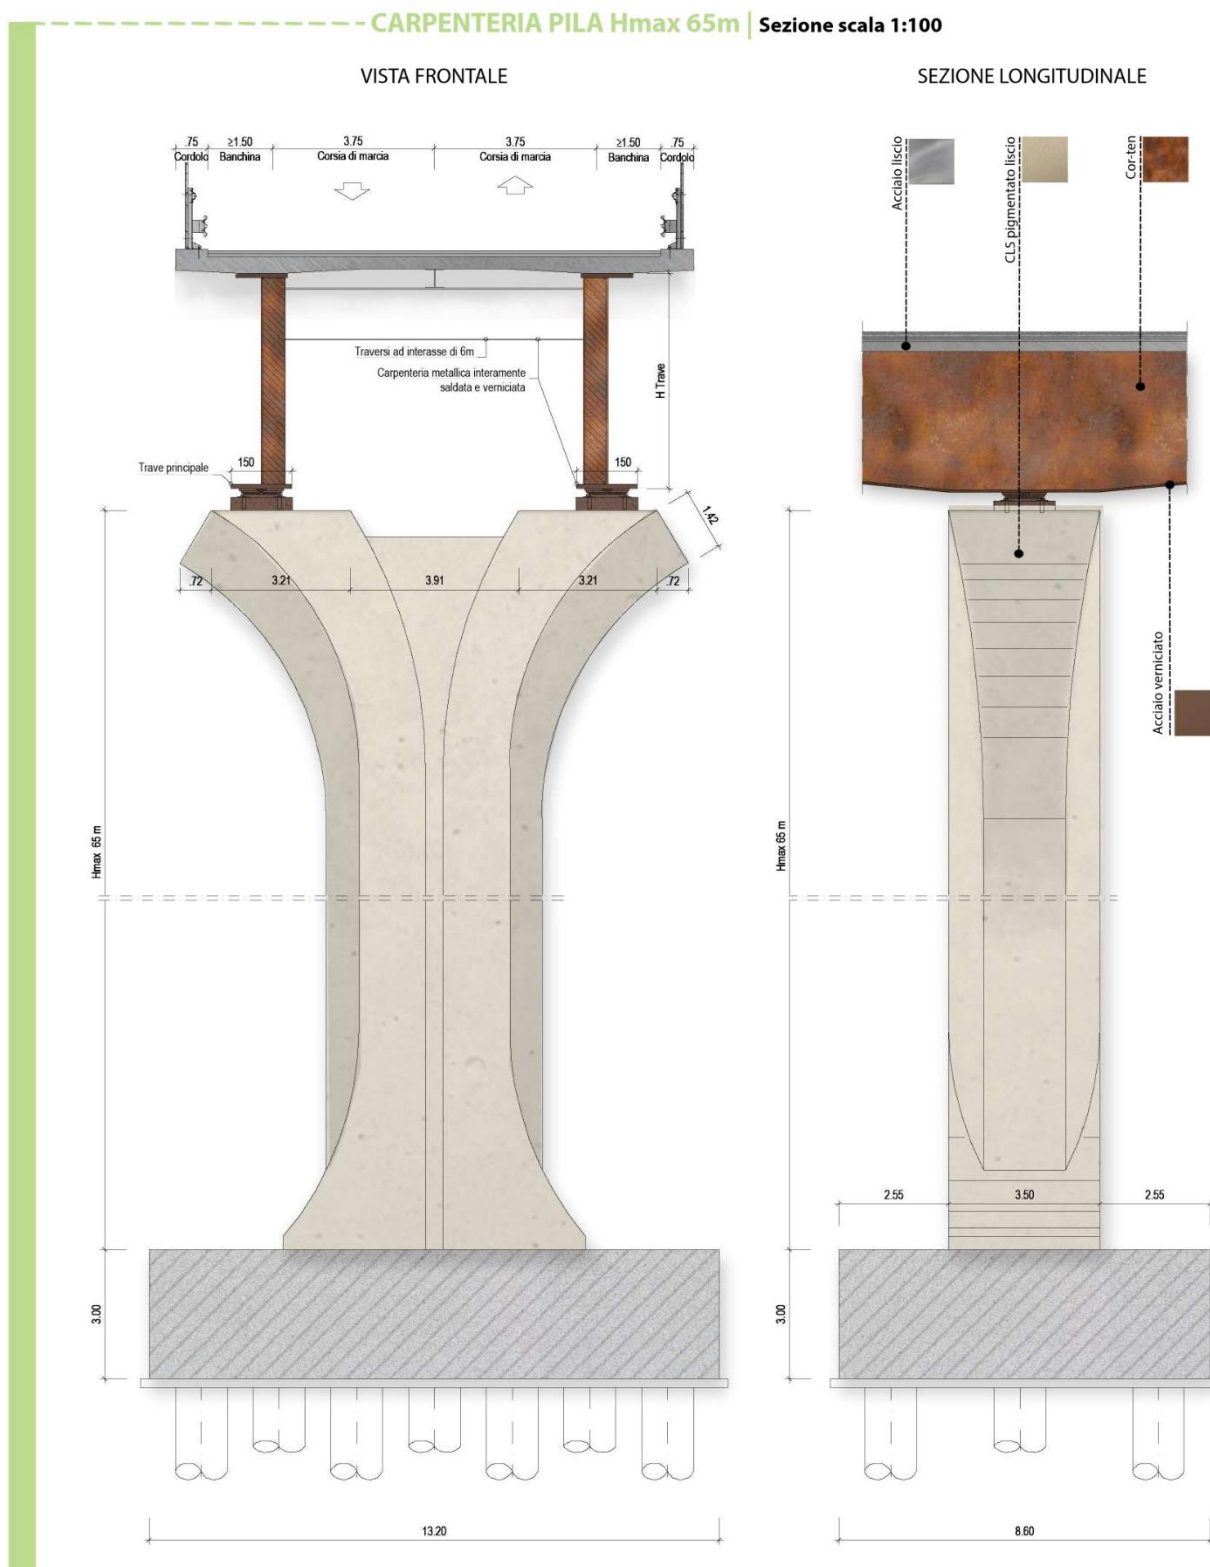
Sezione trasversale pila impalcata asse principale e fondazione su pali
